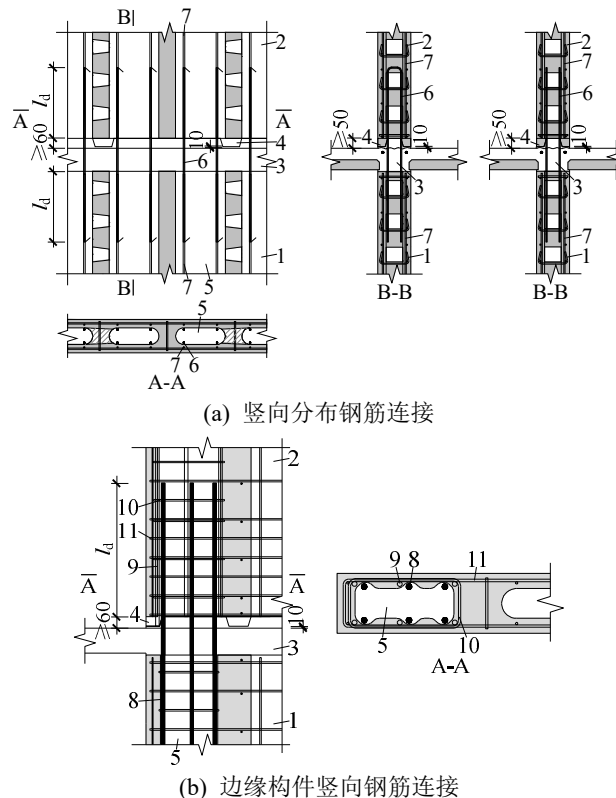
空心墙板水平接缝处竖向钢筋连接构造示意
